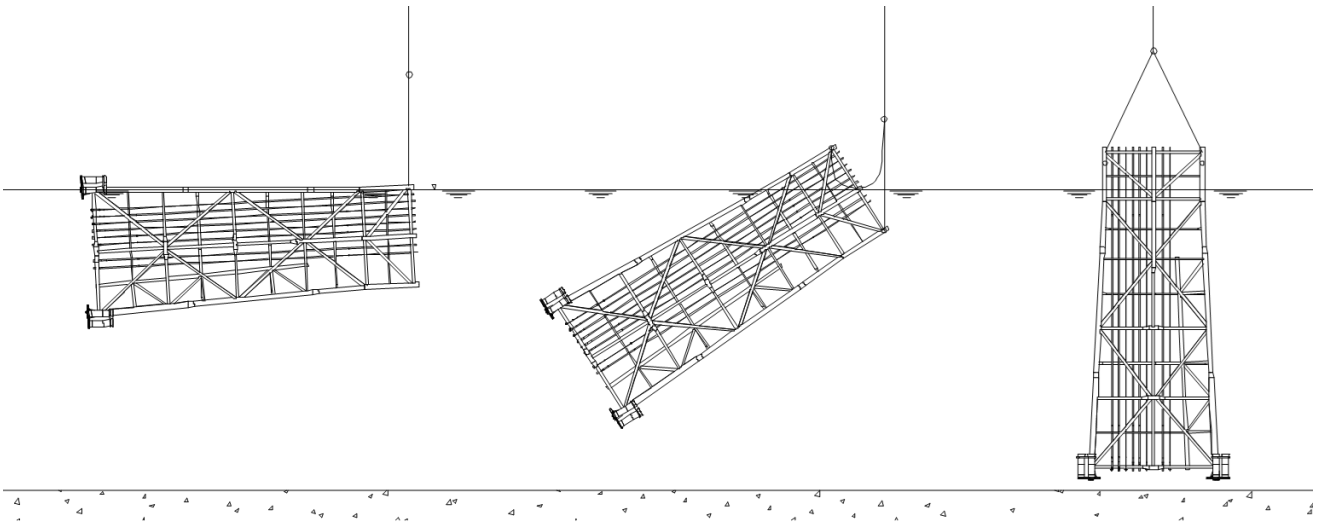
Jacket – Sequenza di verticalizzazione e posizionamento sul fondo
